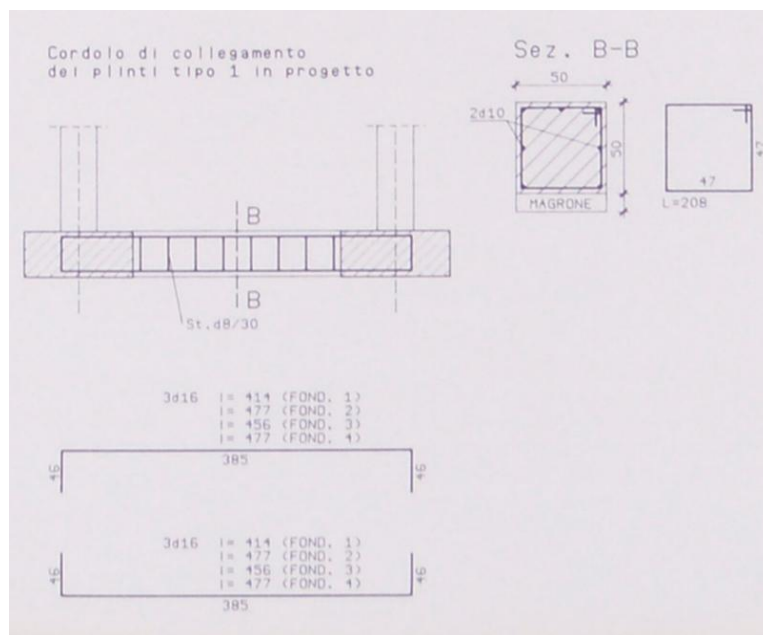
Particolare di A.1996.cap.sa.T02 - Strutture di fondazione e pilastri eseguiti in opera - Cordolo di collegamento
